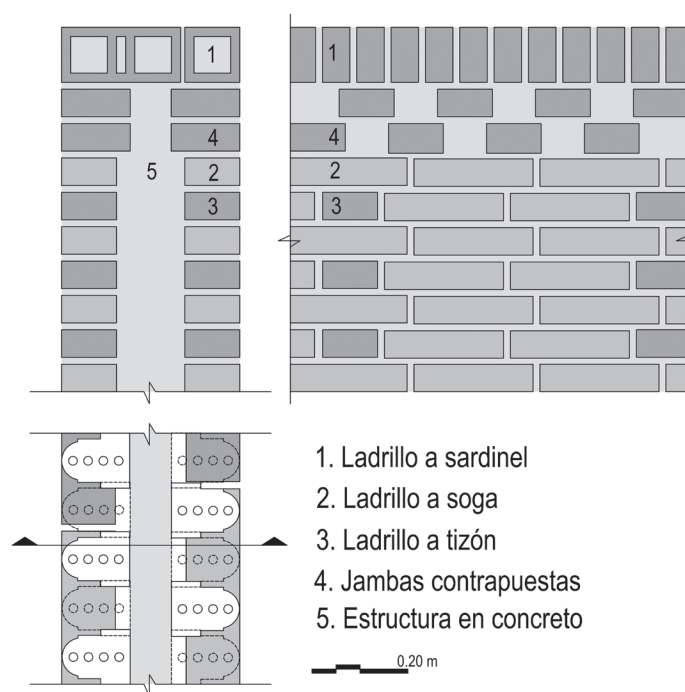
Corte, planta y alzado del muro. El enmascaramiento del sistema estructural. Biblioteca Virgilio Barco. Fuente: el autor
